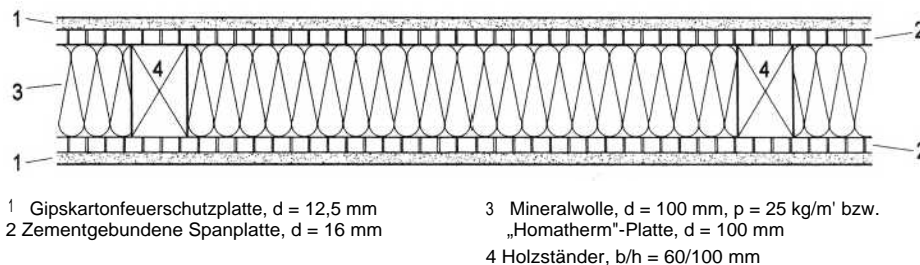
Wandquerschnitt einer möglichen BA - Bauweise
